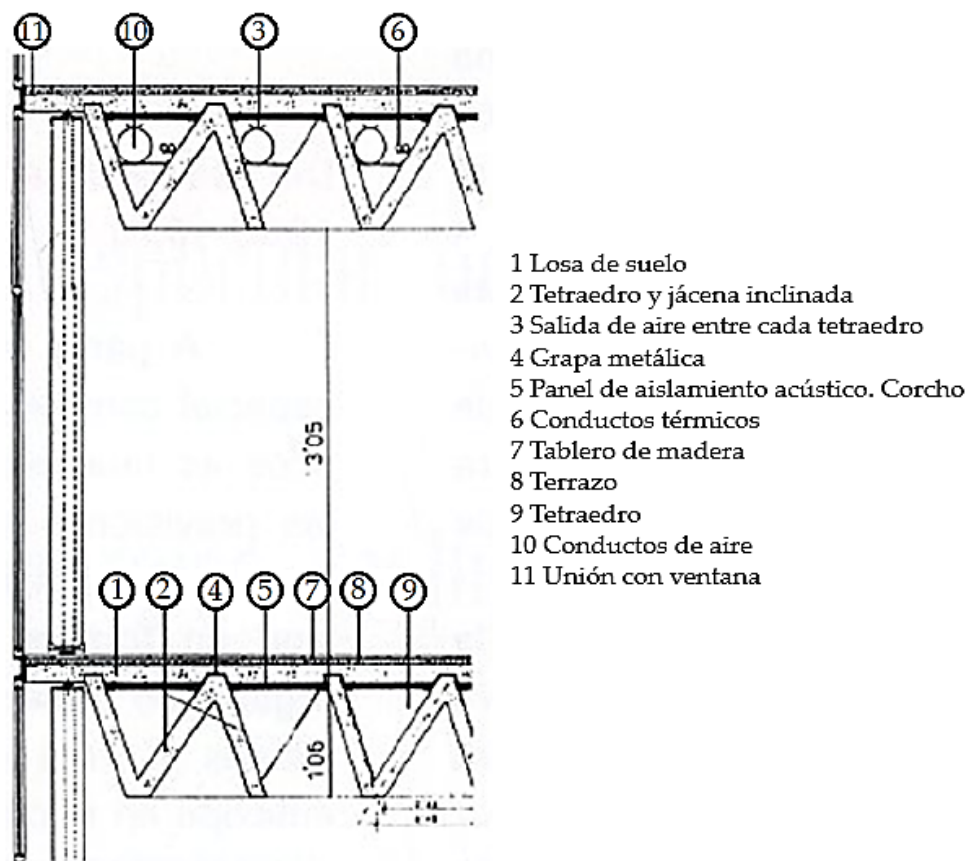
Alzado-Sección del forjado, indicándose los elementos constructivos que lo conforman
